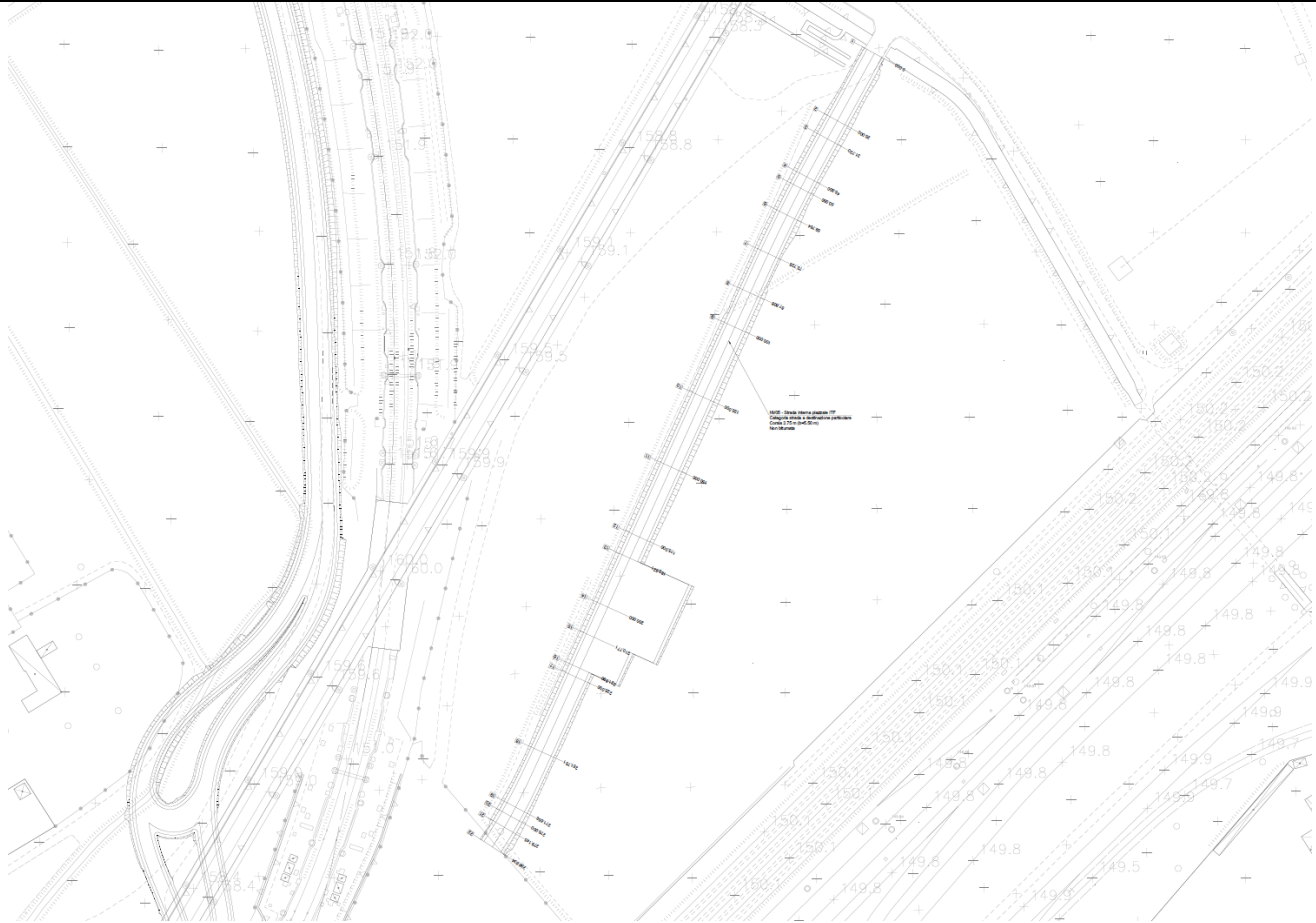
TRACCIATO PLANIMETRICO VIABILITÀ NV05
